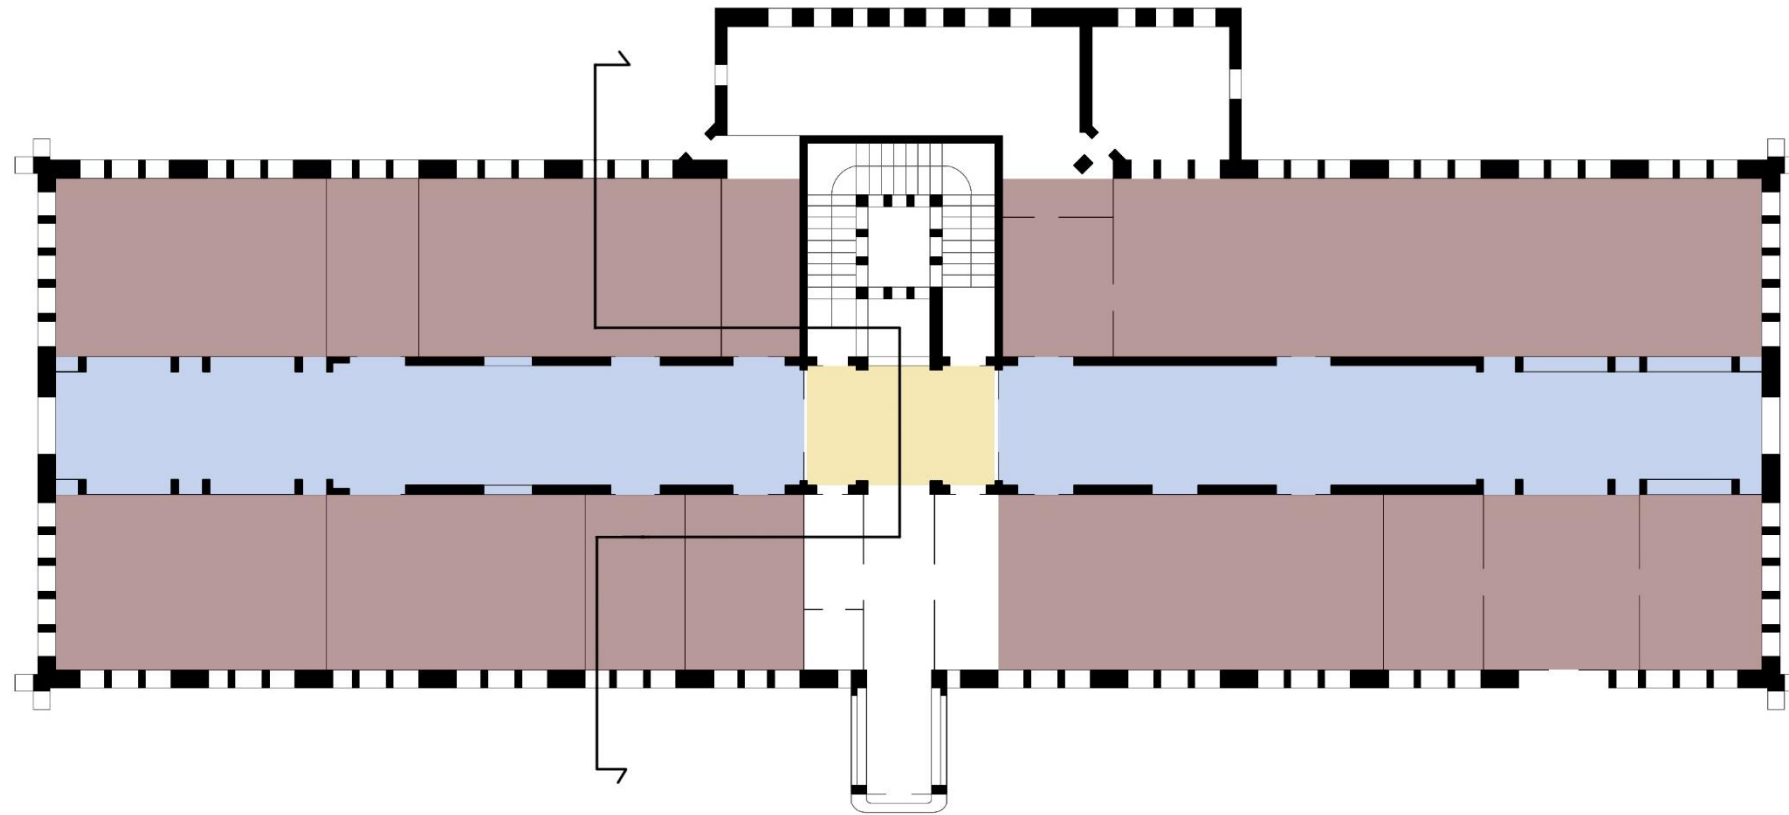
Antoni Gaudí. Plano de planta baja del Colegio de las Teresianas. E. 1/250. Elaboración propia.
